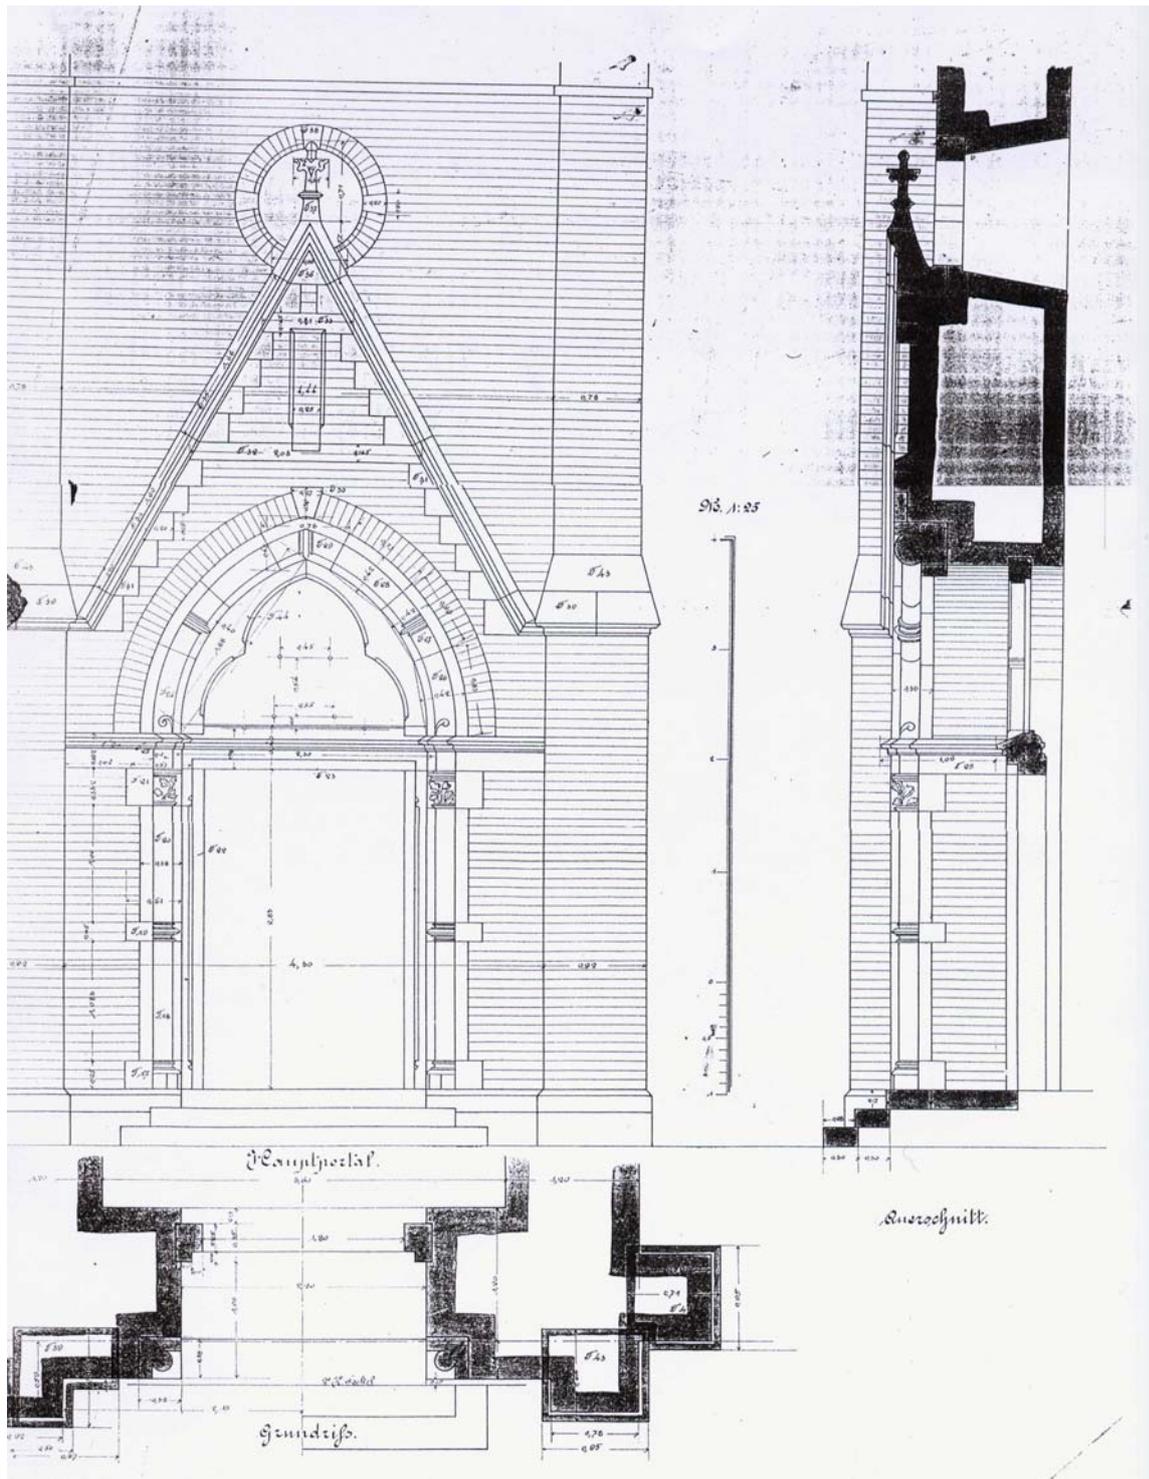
H. Plange, Evangelische Kirche Vohwinkel, Aufriss- und Grundrisszeichnung des Eingangs, 1889
